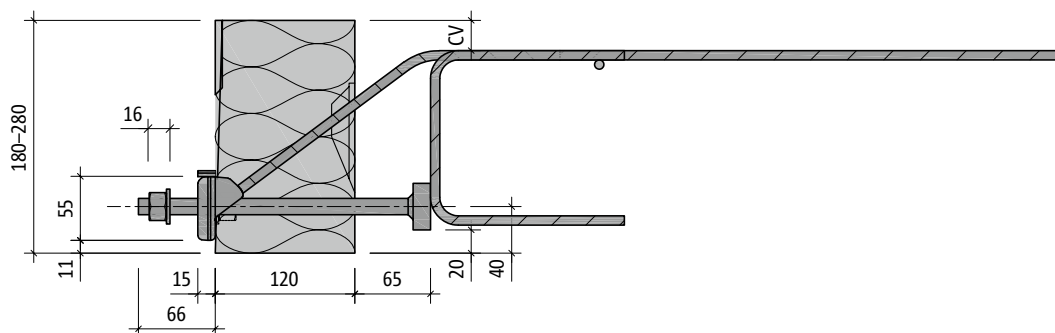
Schöck Isokorb® XT tipo SQ-V1: Sección del producto
